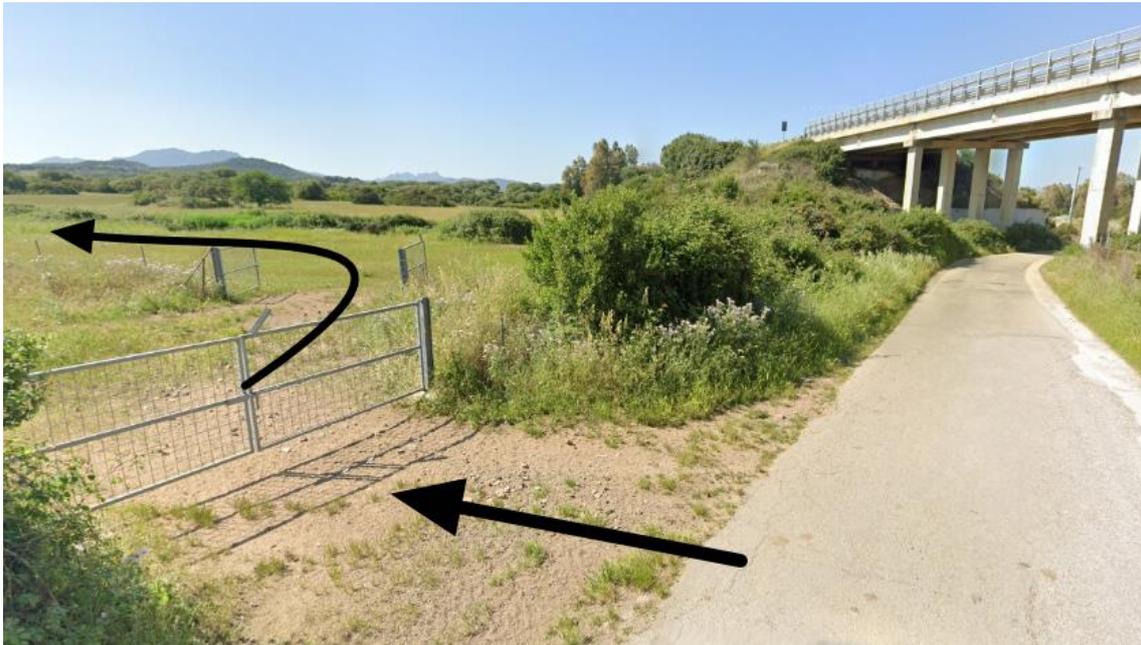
Foto dell'accesso all'area di cantiere tramite pista di cantiere a partire da via Siena .
